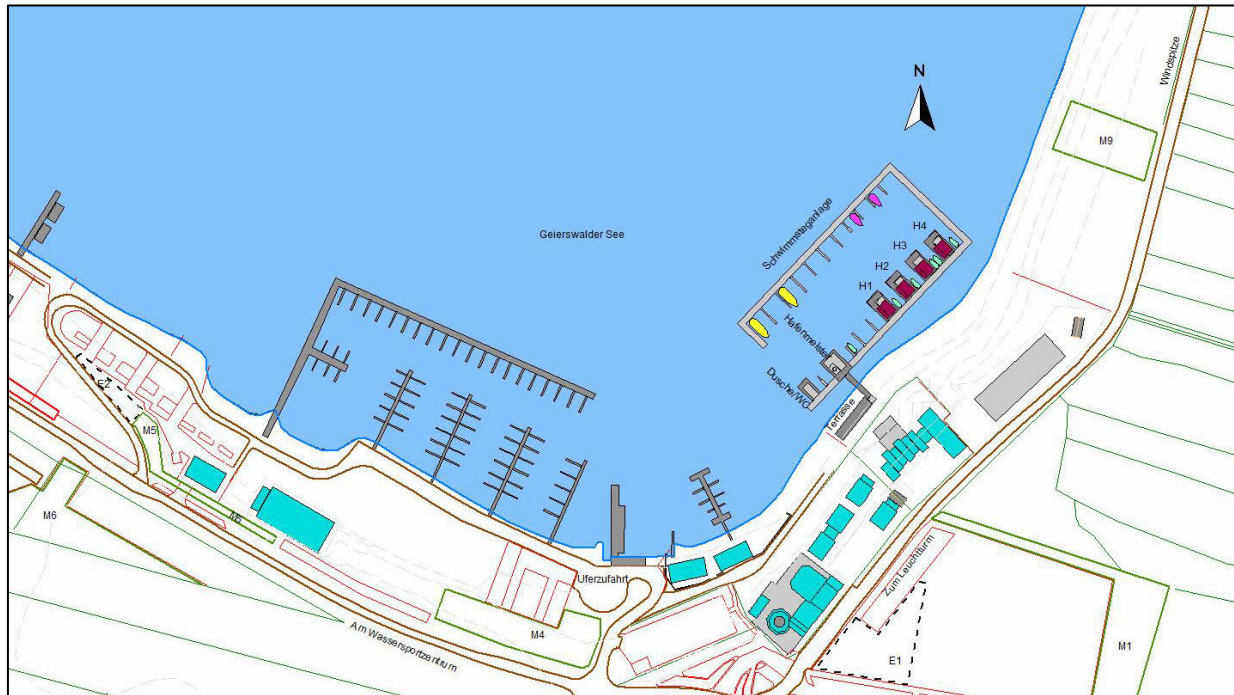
Lageplan (Rechenmodell) VB-Plan „Schwimmsteganlage“
